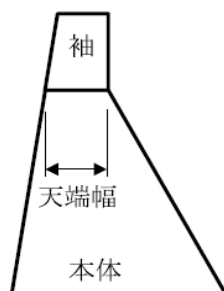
砂防堰堤側面図（事例）と部位名称
